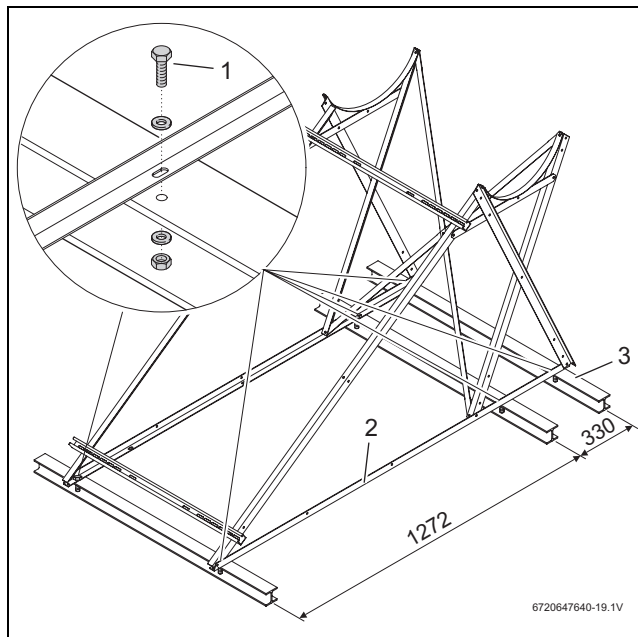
Connexion au toit pour le système toit terrasse sur des supports I (ici pour système 150/200 I)
